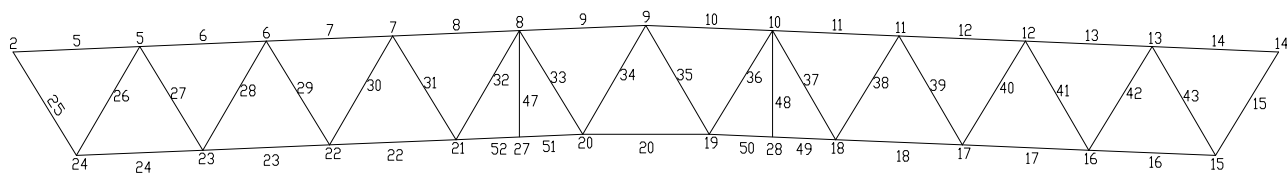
Схема нумерації вузлів і стержнів ферми
